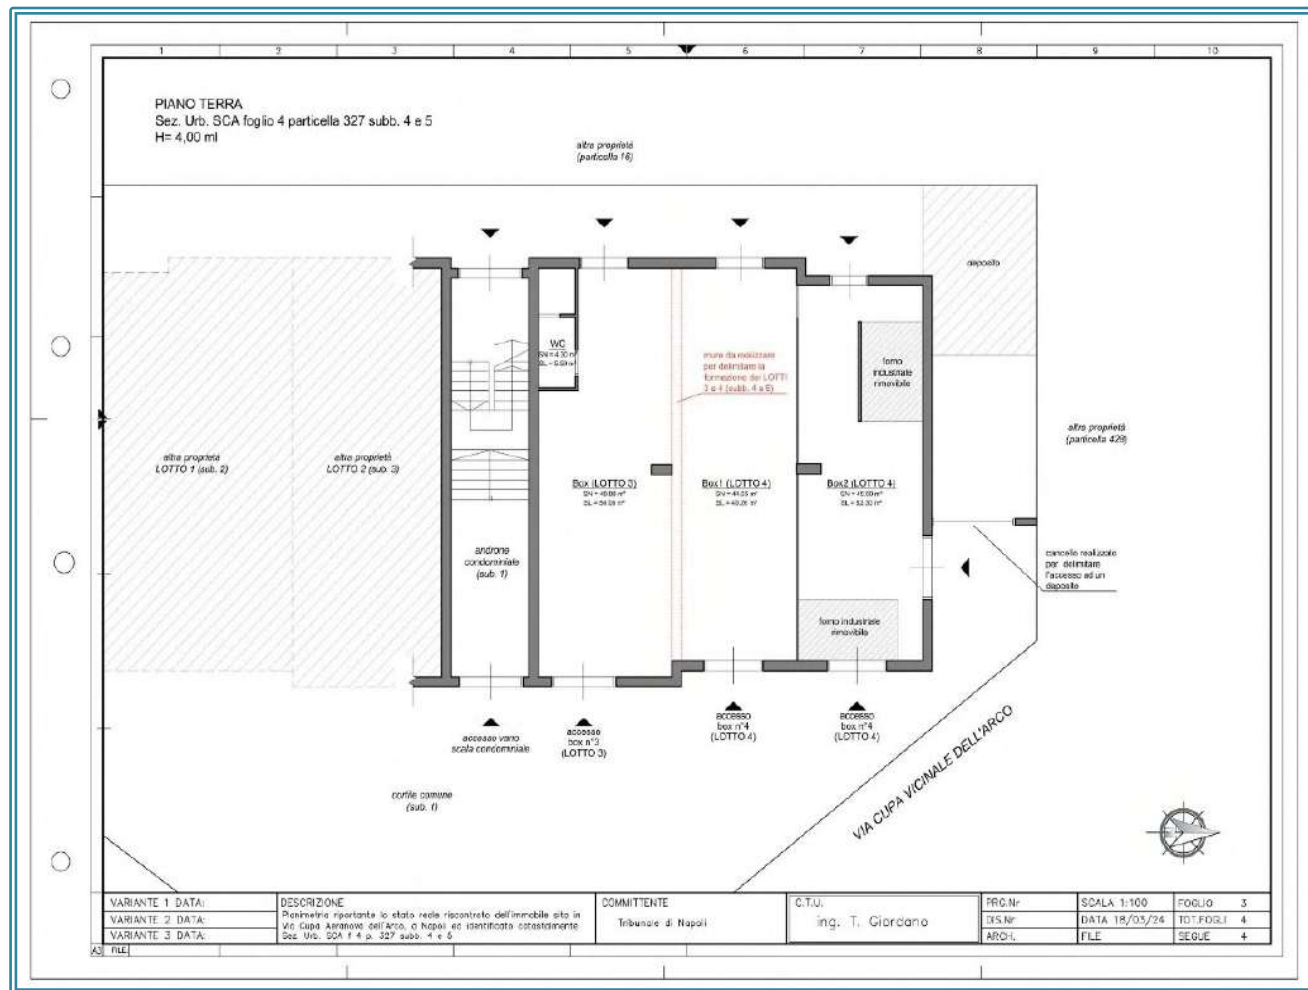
Planimetria stato attuale LOTTI 3 e 4
